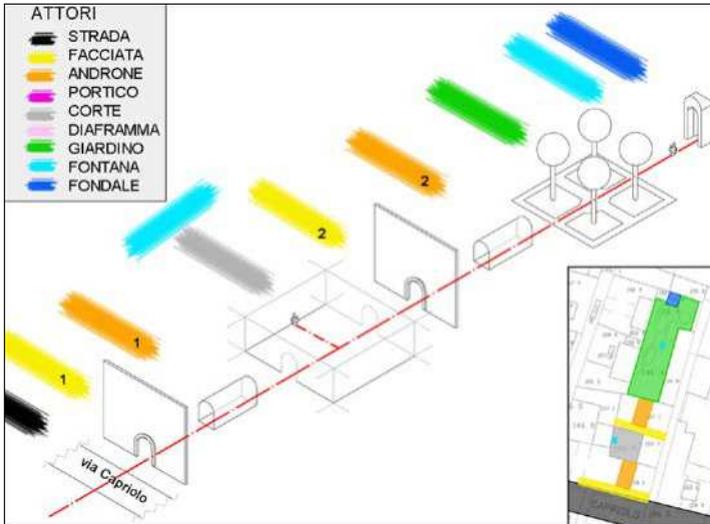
Esempio di ricomposizione grafica degli elementi base di una sequenza prospettica con componente cromatica, vista tridimensionale e schema planimetrico (I. Passamani).
